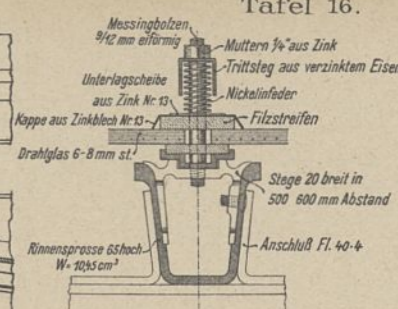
Querschnitt der Rinnensprossen für Oberlichte. 1:5.
